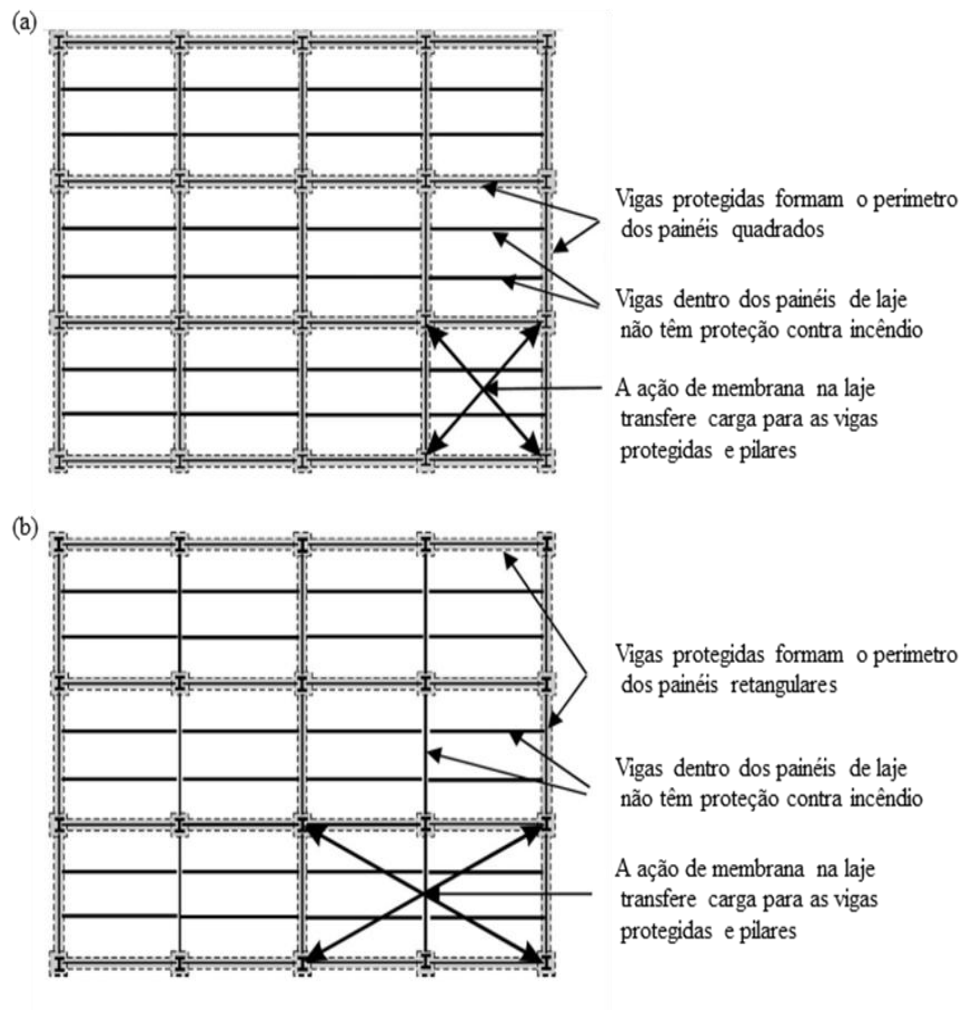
Divisão da laje de piso em painéis de laje. Laje de piso dividida em (a) painéis quadrados e (b) painéis de laje retangulares (C.G. Bailey, 2004).
